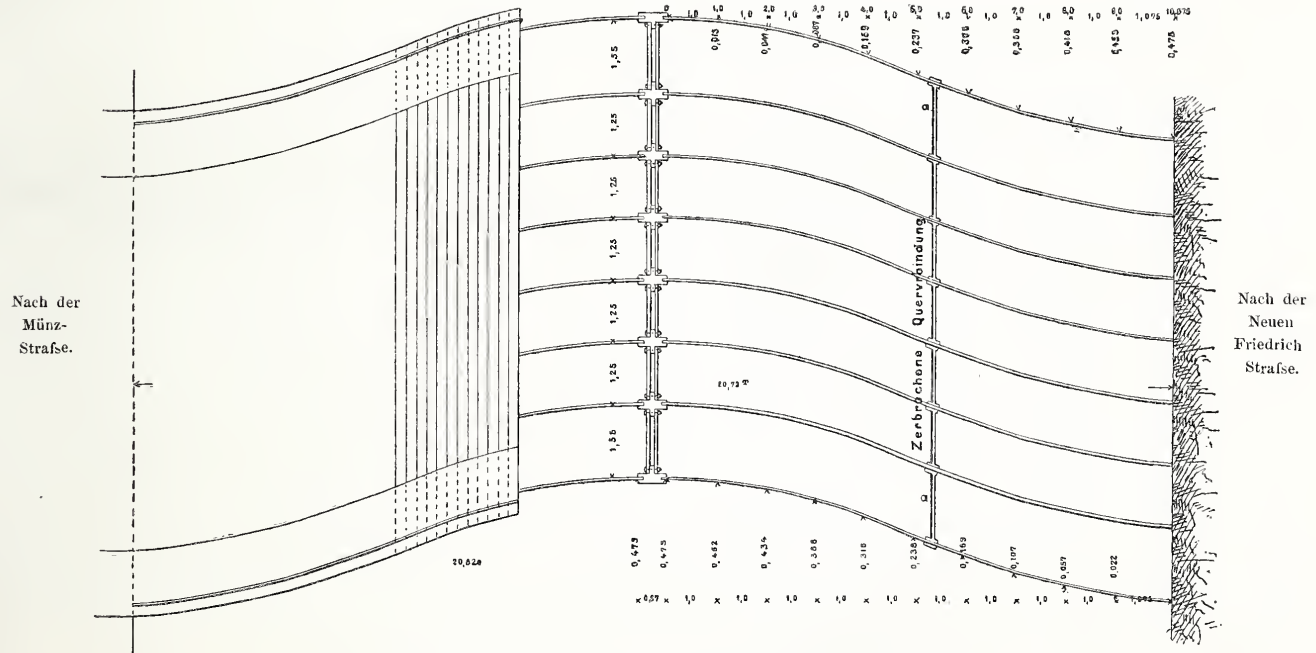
Grundriss. (Maafstab 1:150; Verbiegungen fünffach übertrieben.)
